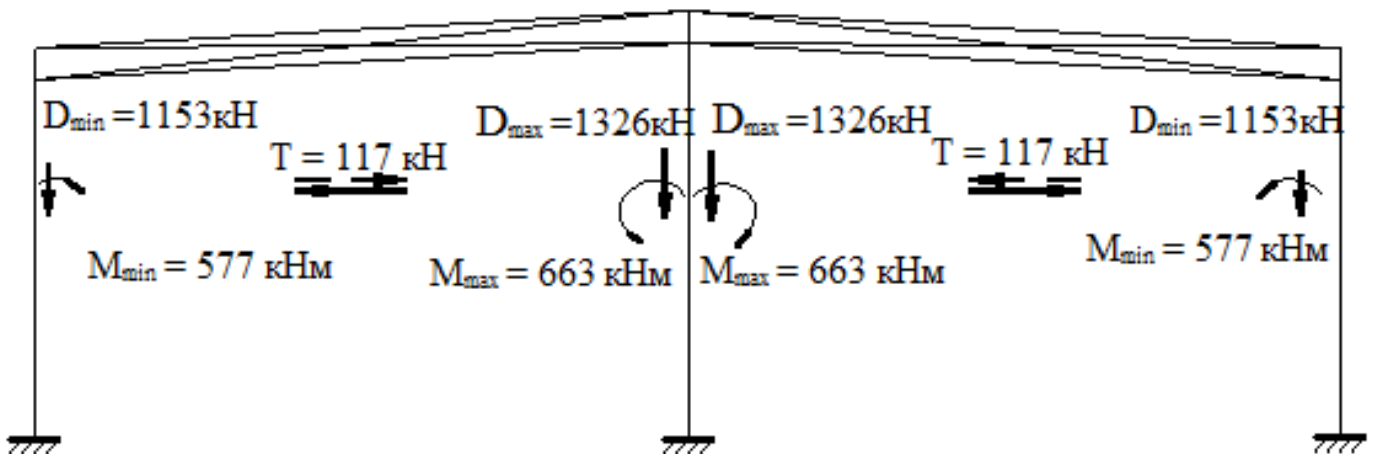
(б) Схема приложения крановых нагрузок №2 (максимальное загрузение средней колонны): кран находится вблизи колонны В пролета АБ, и вблизи колонны В пролета ВВ.
